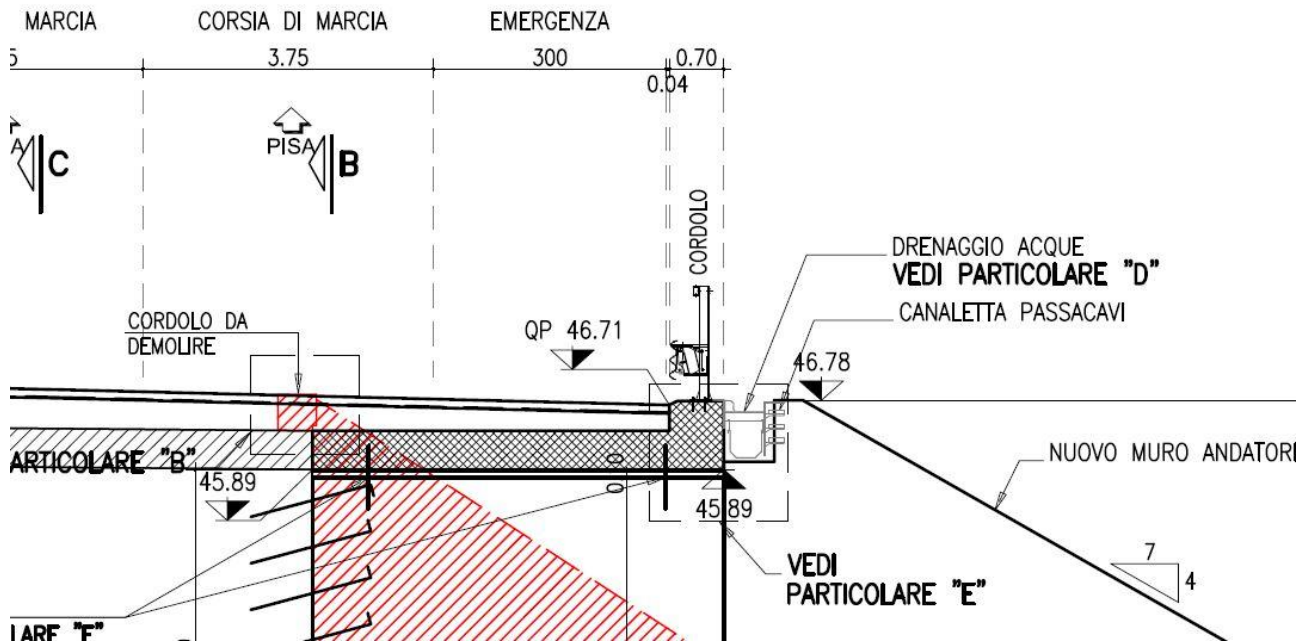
Sezione tipo struttura ampliamento sottovia.
